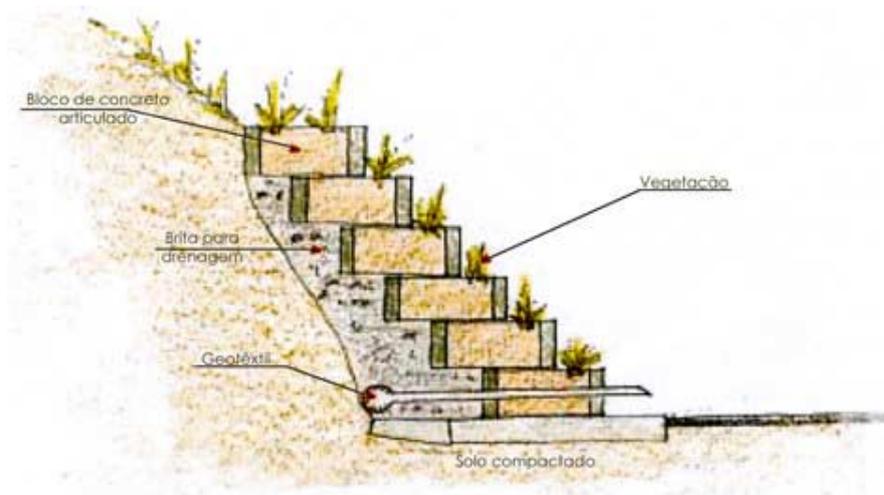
Croqui esquemático de muro de arrimo, com plantio de vegetação
